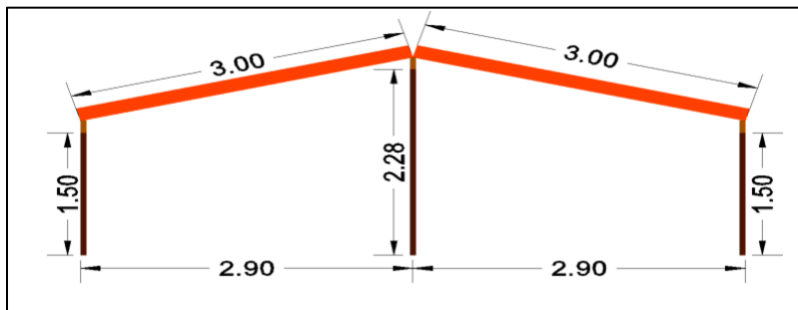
pórtico con inclinación; Fuente: (Silva & Valencia, 2023)
